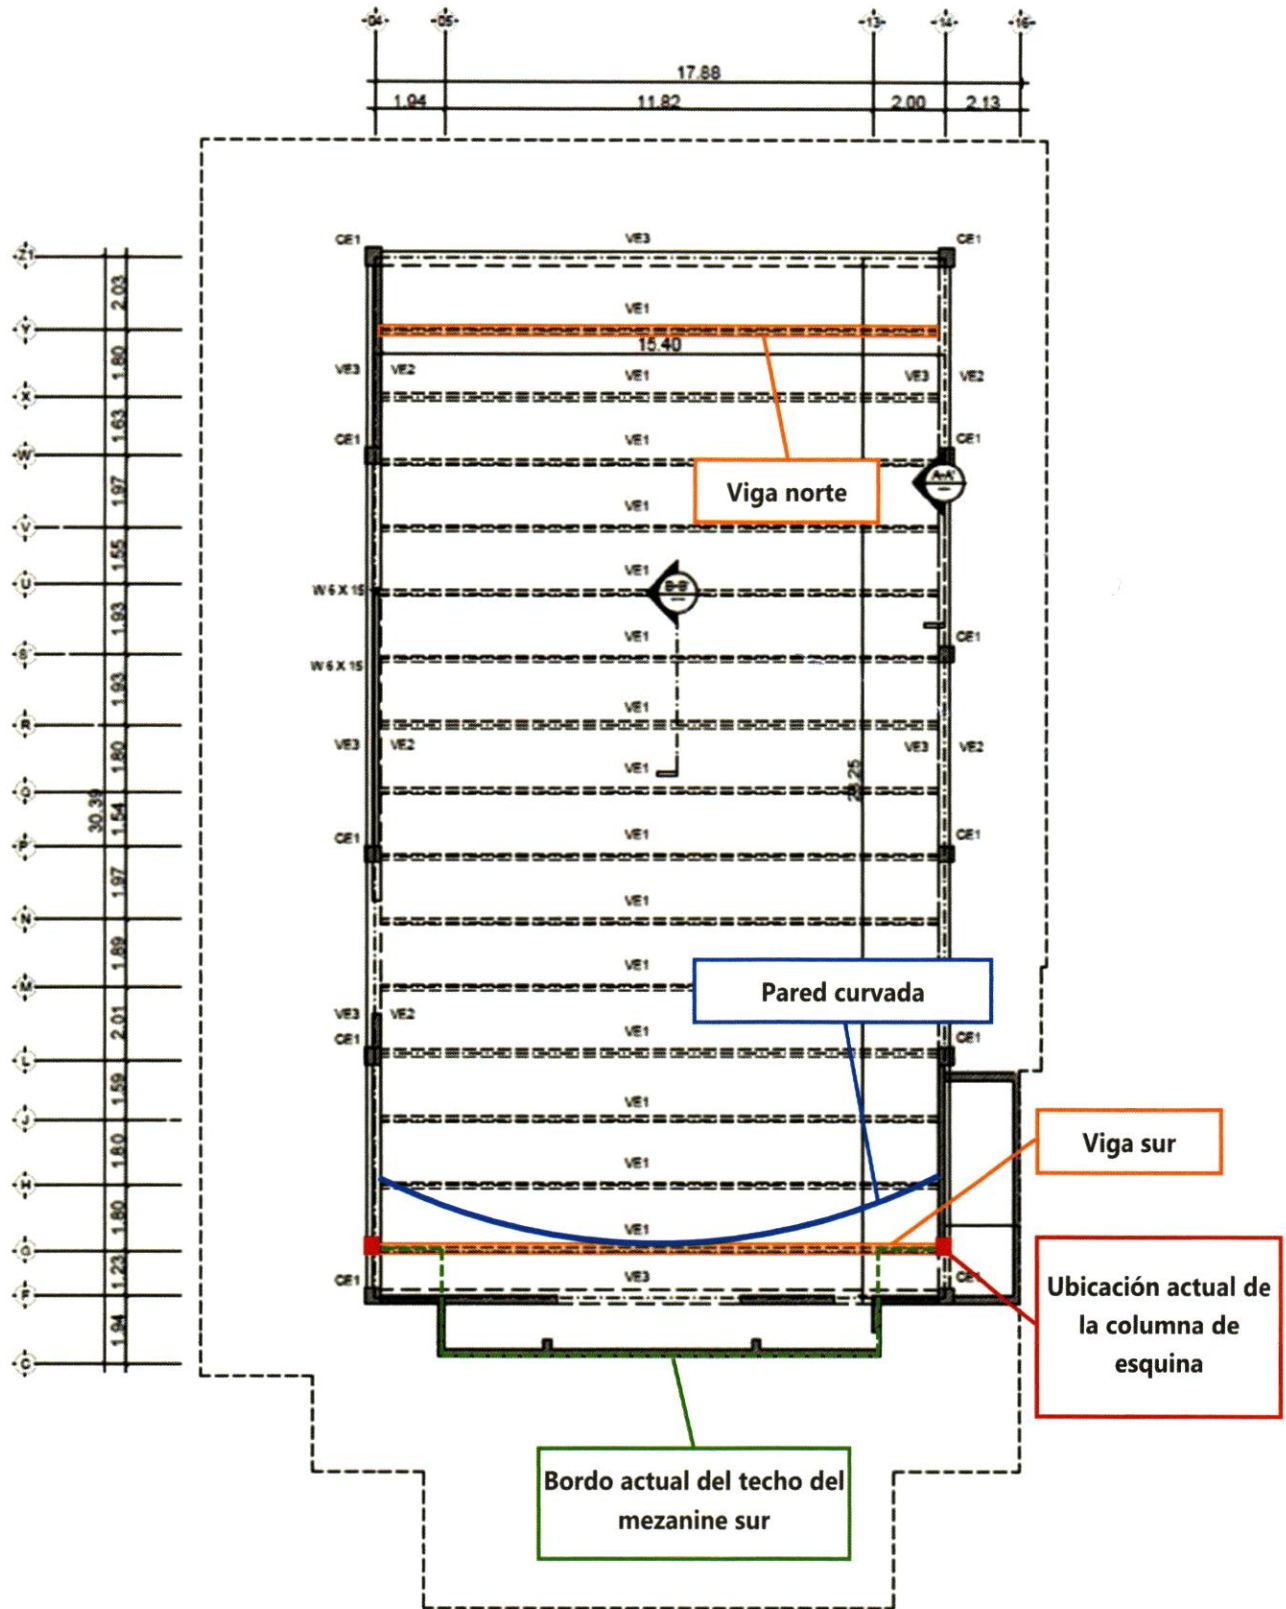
Extracto anotado en planta de la estructura del techo, basado en los planos del gobierno.
